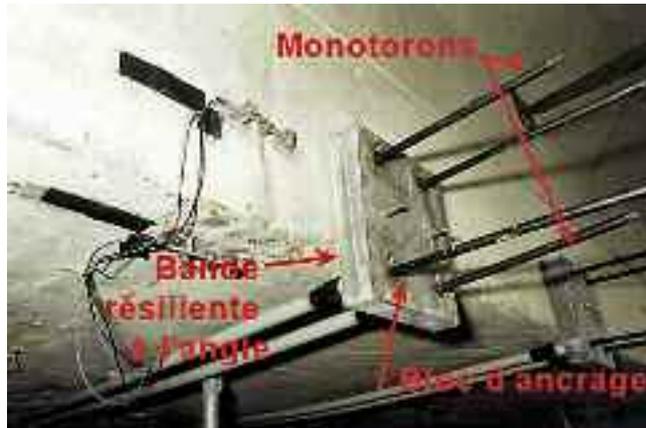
ancrages de précontrainte additionnelle transversale avant capotage (crédit photo Sétra)
